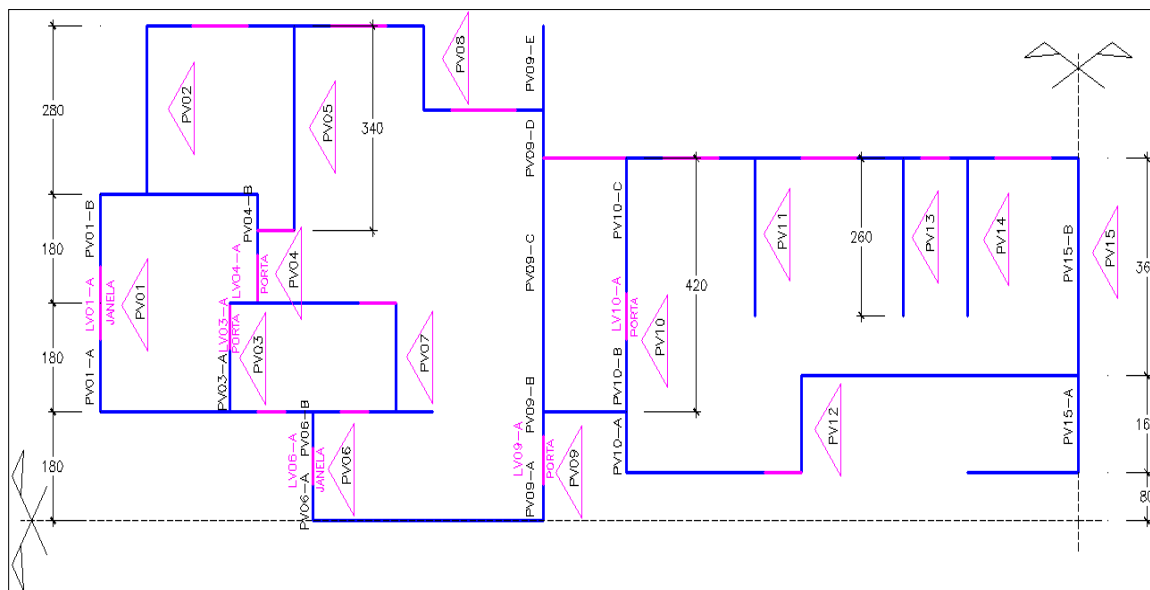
Planta baixa das paredes do edifício Niterói na direção vertical.
